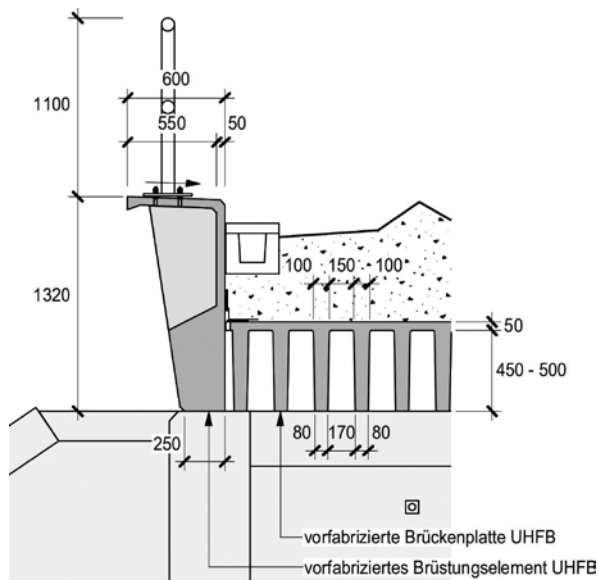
Querschnitt des Randträgers aus bewehrtem UHFB (Abmessungen in mm)
